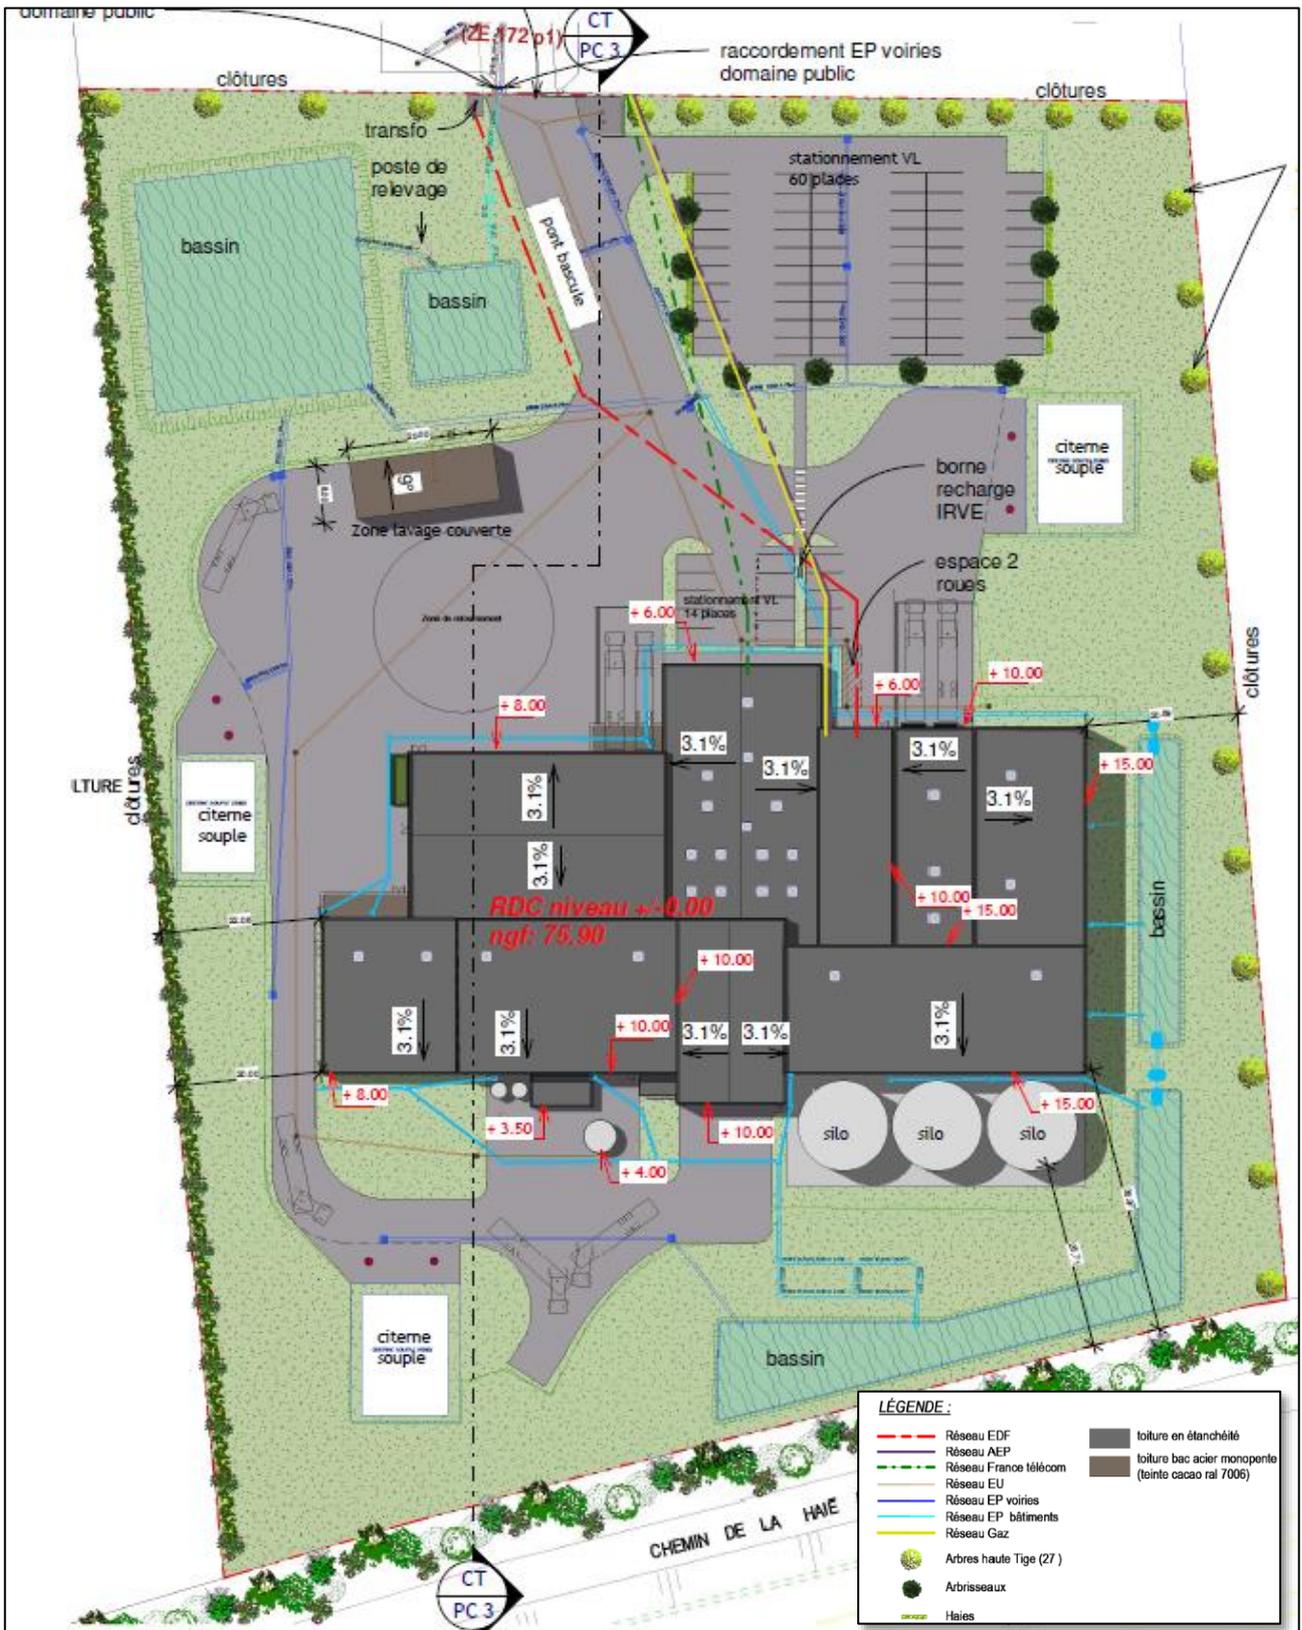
EXTRAIT DU PLAN DE MASSE DU PROJET
